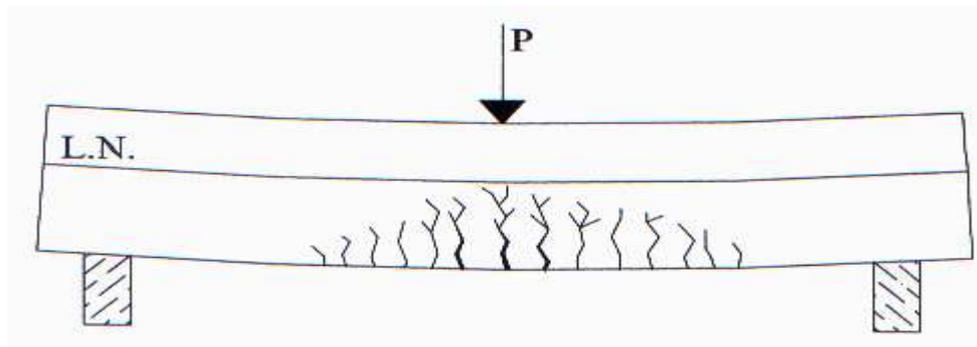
Configuração da fissuração por flexão em vigas
